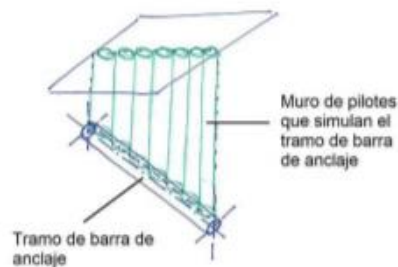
Barra de anclaje y su consideración como muro de pilotes a efectos de cálculo.
